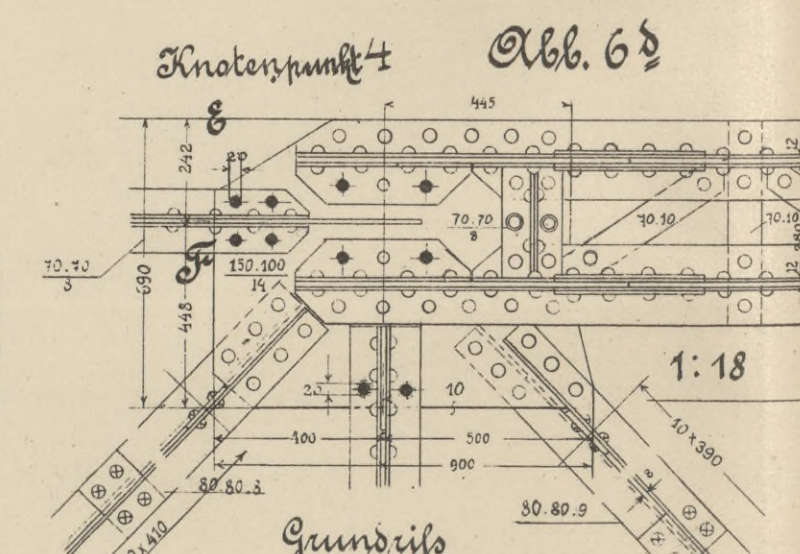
Knotenpunkt 4 Grundriß 1:18
